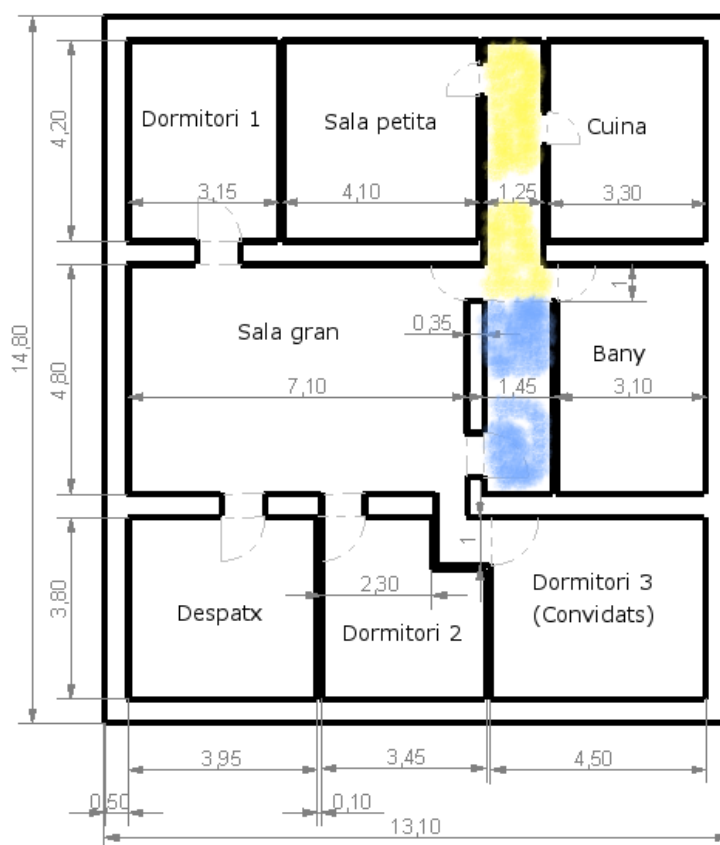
Plànol planta central Espinoi. Color groc: Passadís. Color blau: Escales. Font pròpia
